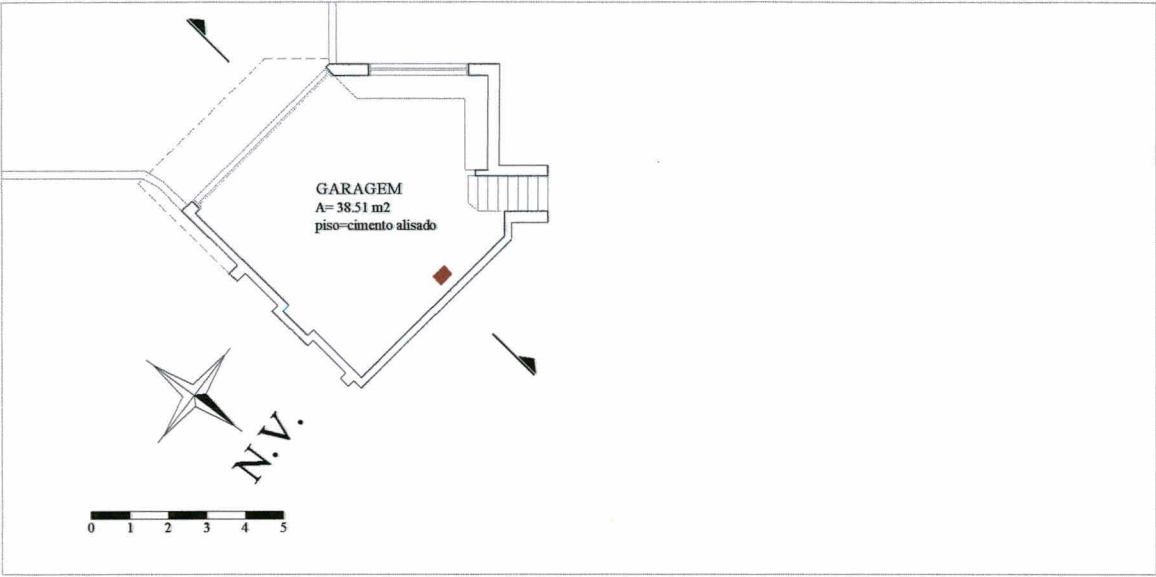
Planta Baixa Pavimento Garagem Residência 2
